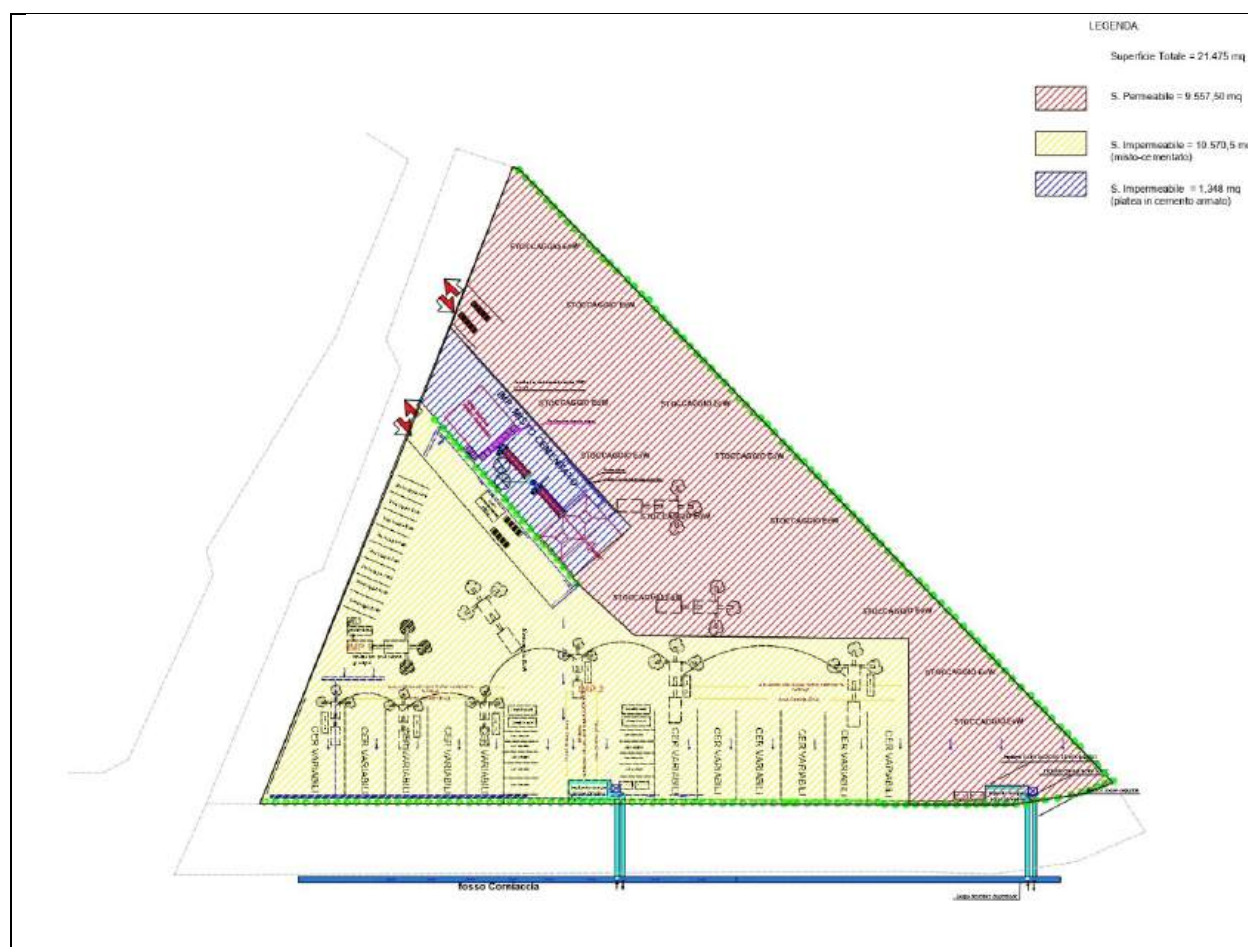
Planimetria con le superfici impermeabili e permeabili.
